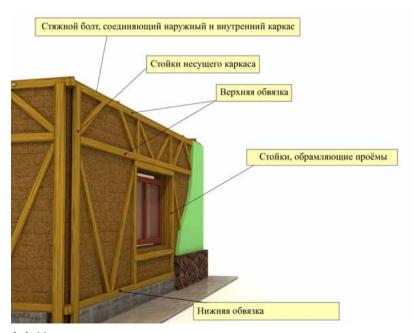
Усиление стен из сырцового кирпича деревянным каркасом
